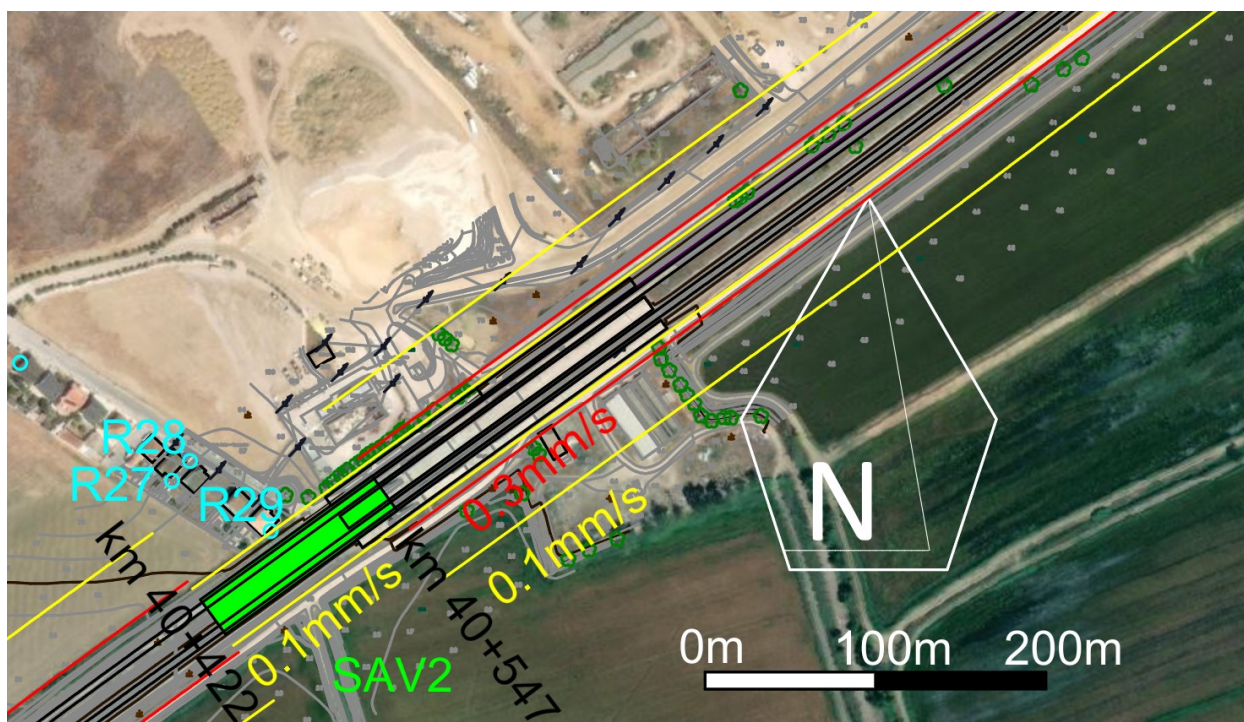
Localização do Sistema Anti Vibrátil tipo manta de balastro SAV2
